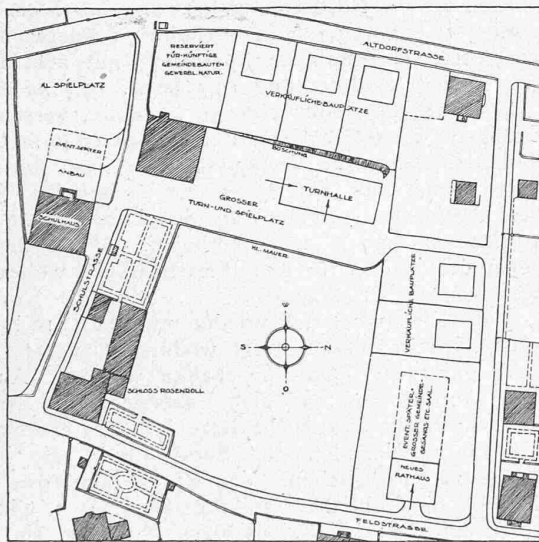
Lageplan des Schulhauses mit neuer Turnhalle. — 1:2000.
